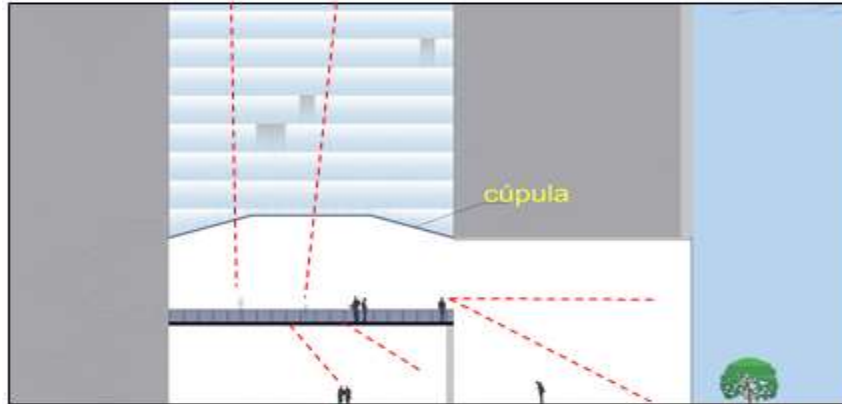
Esquema del Criterio Espacial / Vista de Planta Baja. Fuente: El Autor. (2023)
